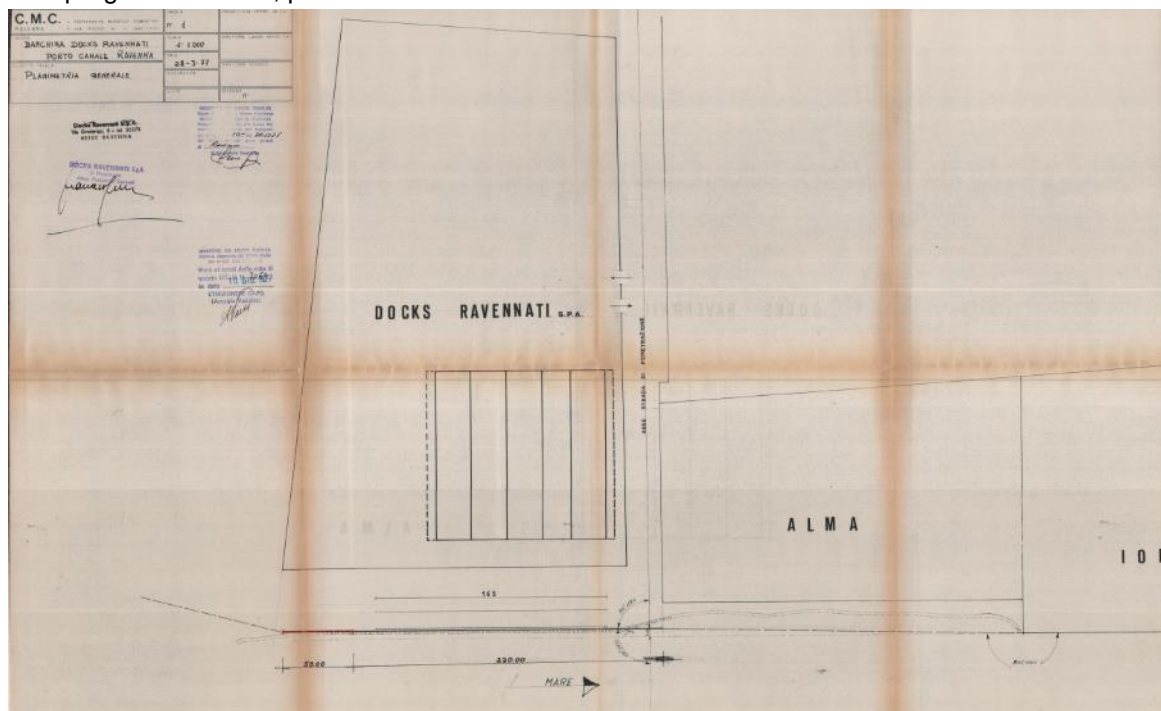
Planimetria generale del progetto di realizzazione del banchinamento del 1977
